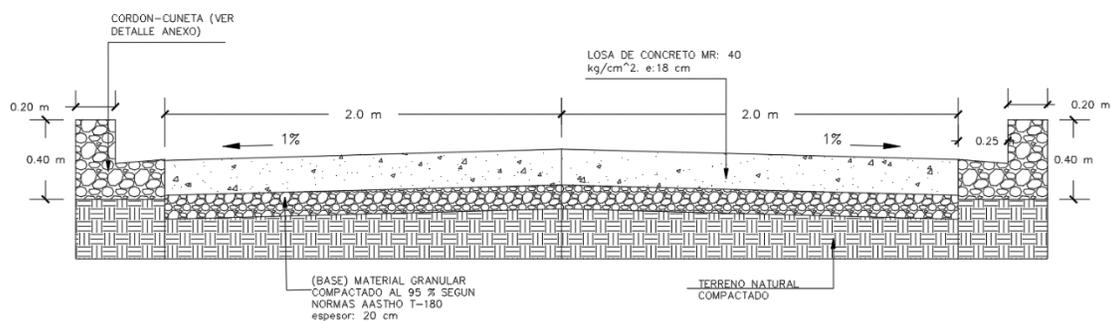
Sección transversal de un pavimento de concreto hidráulico (rígido).
